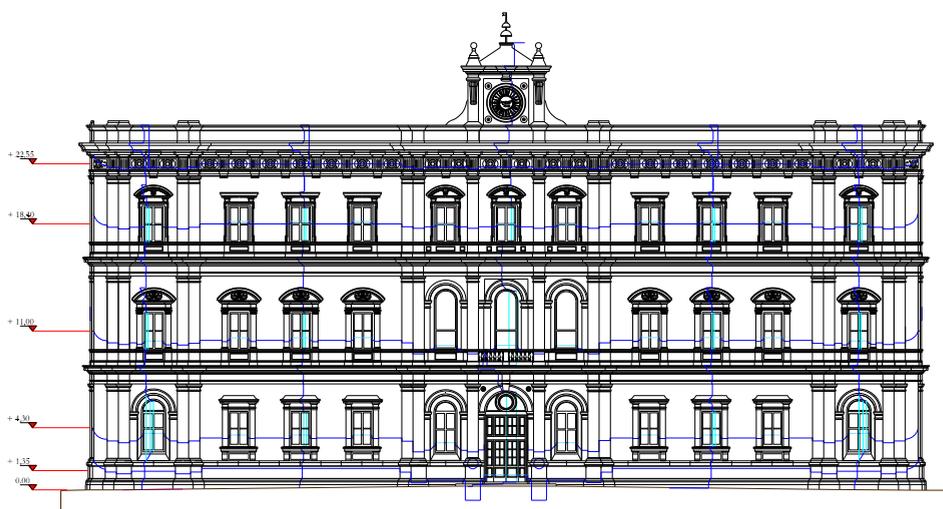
Restituzione vettoriale del prospetto ovest con l'indicazione delle sezioni orizzontali e verticali.
